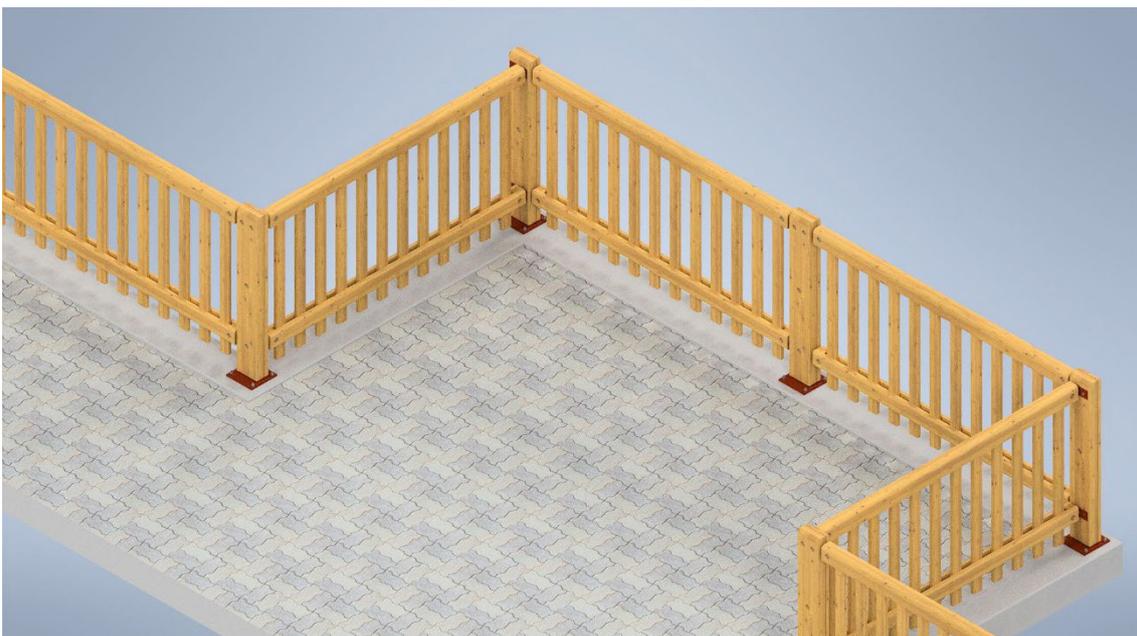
Montaggio del parapetto su struttura con angoli di 90 gradi – modalità B
